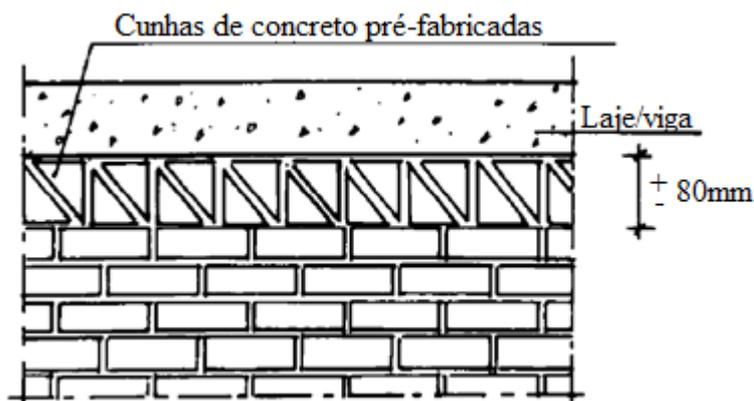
Travamento entre alvenaria e estrutura com cunhas de concreto pré-fabricadas.
